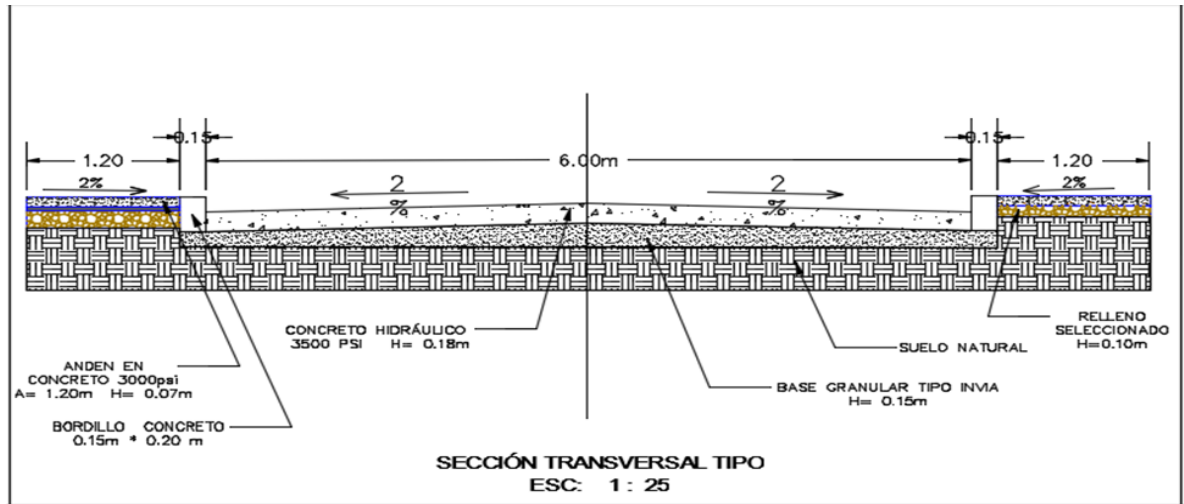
Sección transversal del pavimento fuente: unión temporal coyupe 2017
